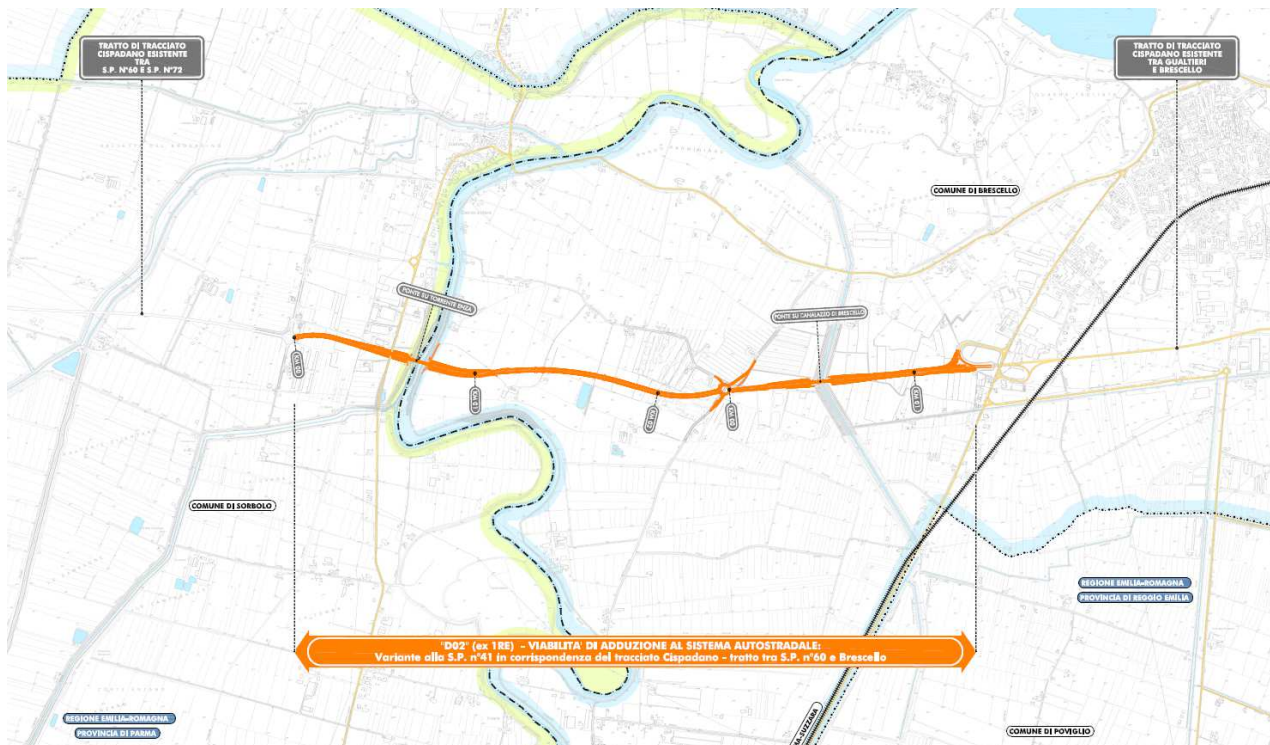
PLANIMETRIA DI PROGETTO – OPERA 1RE
